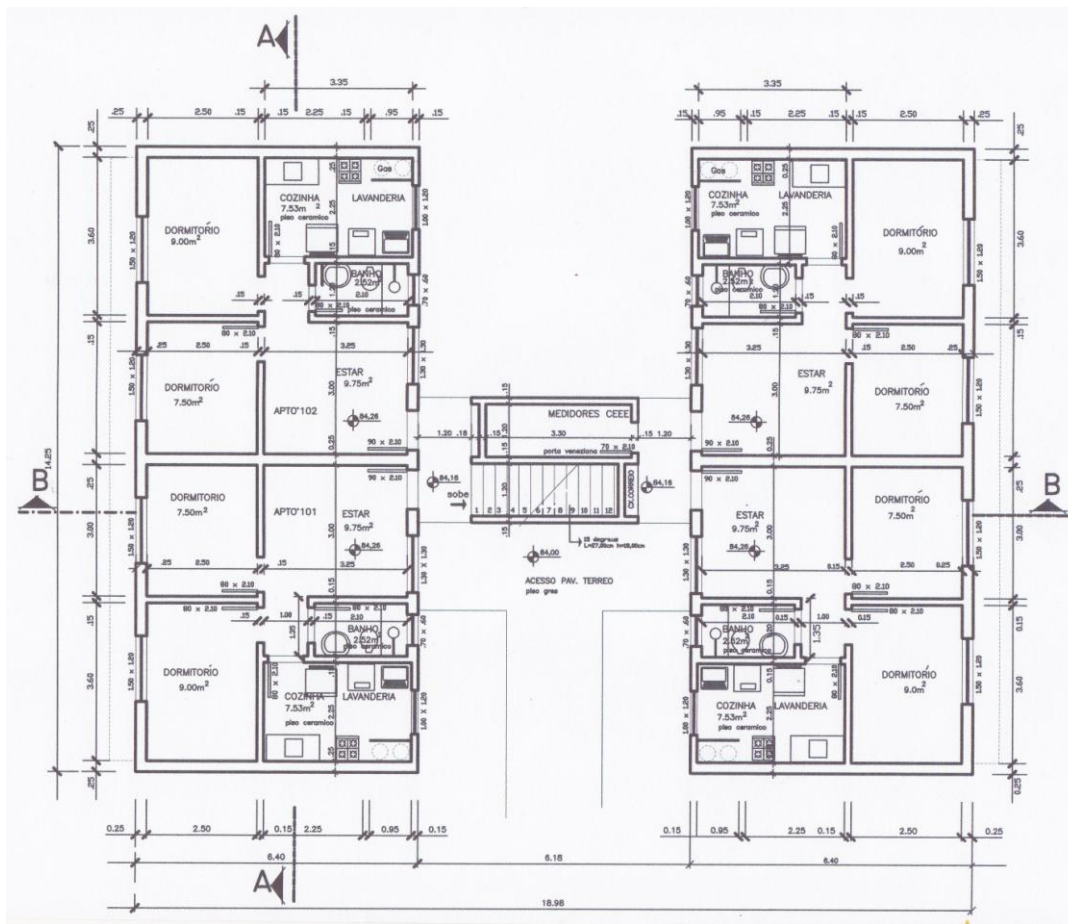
Plano de la planta baja del conjunto de edificios Amizade.
